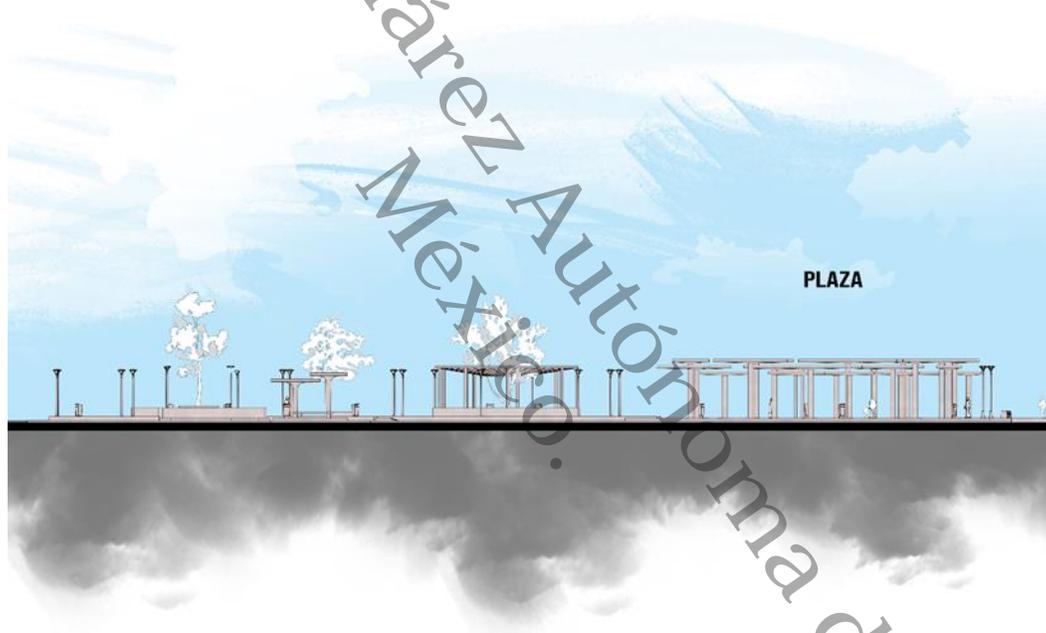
Alzado sección A. [Figura]. Fuente: Autores (2024).
